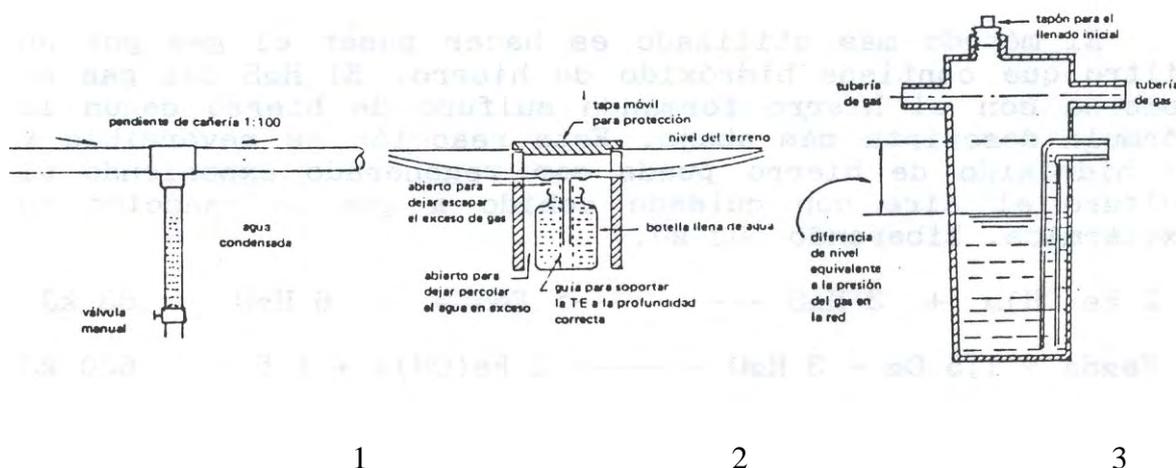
Tipos de drenaje: 1) Simple tipo “T”; 2) Automático subterráneo; 3) Automático tipo “sifón”
